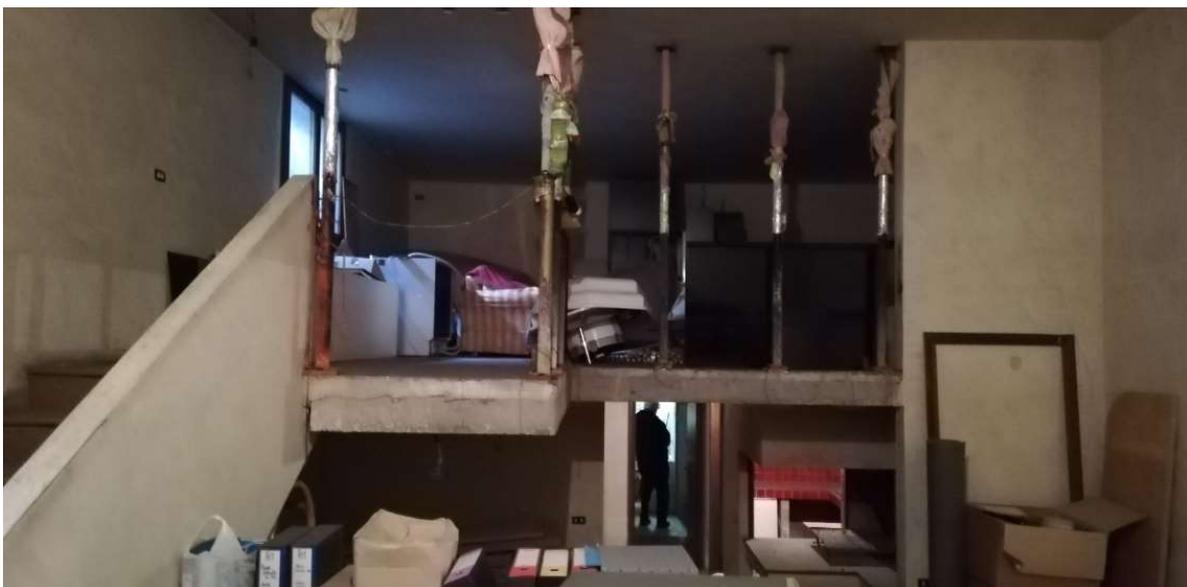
Piano interrato - Locale taverna disposto su due livelli
